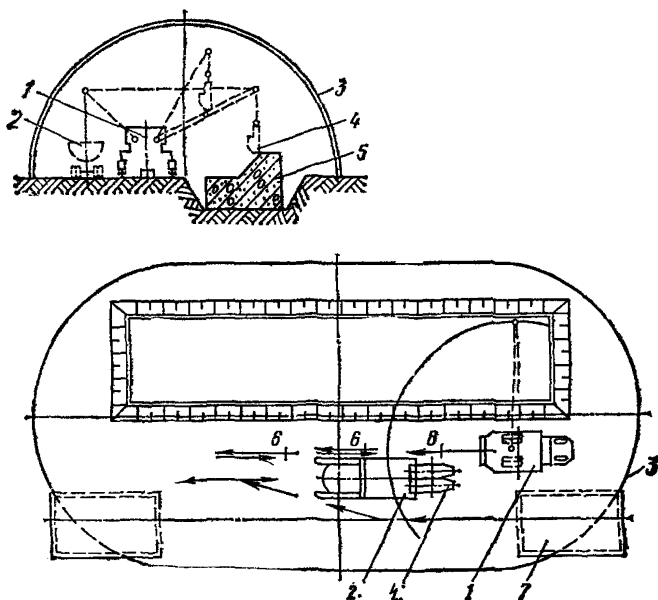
Механизированная укладка бетонной смеси в тепляке с использованием схемы «кран — бадья»
